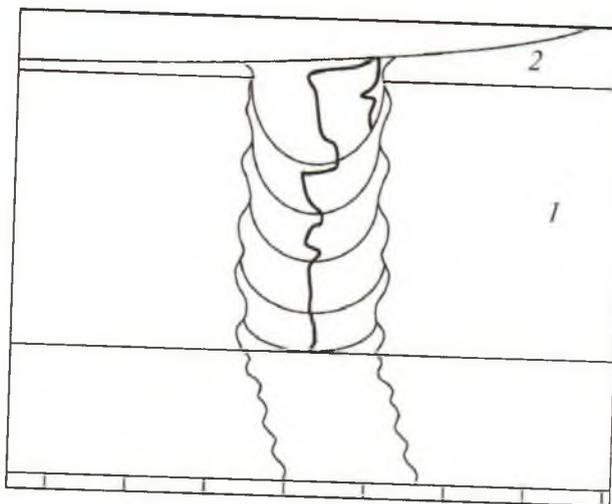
Трещины в стыковом сварном соединении крановых рельсов КР80. Вид головки рельса сбоку. Трещины распространяются вдоль валика по всей боковой поверхности 1 головки с выходом на поверхность катания 2
